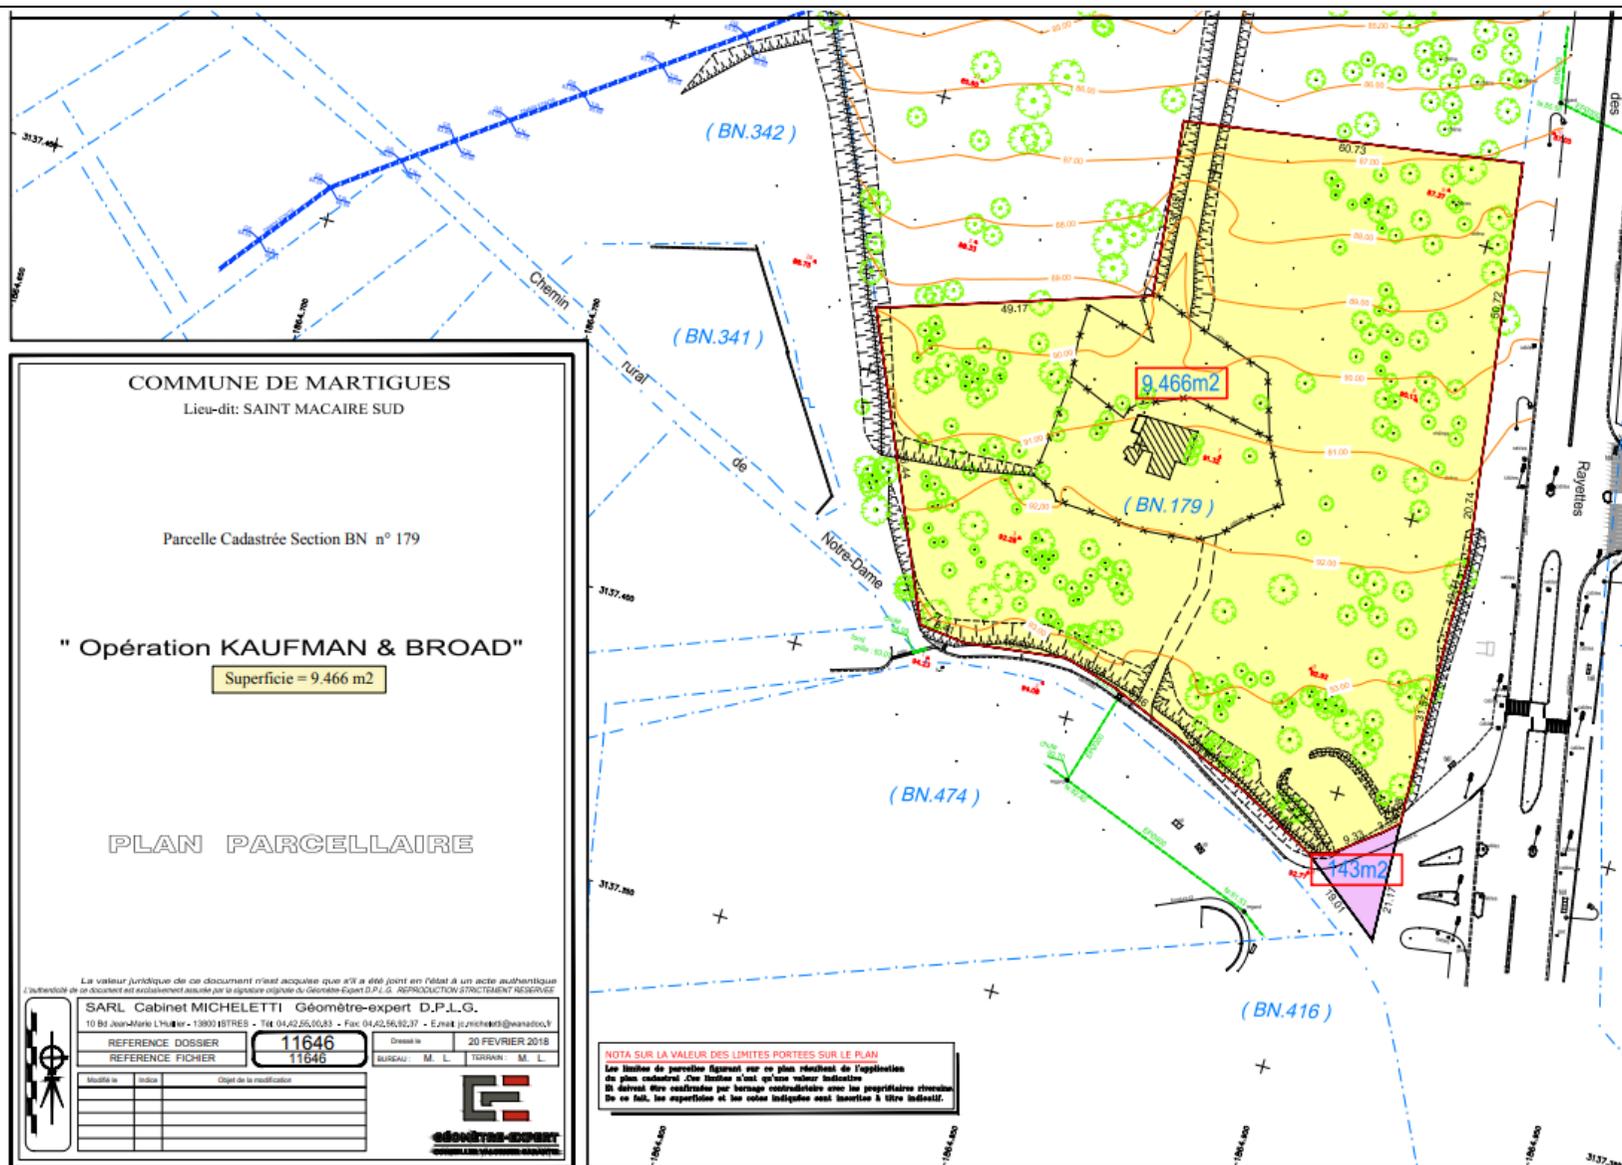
Plan de la zone d'emprise du projet sur fond cadastral (Source : Cabinet MICHELETTI)
